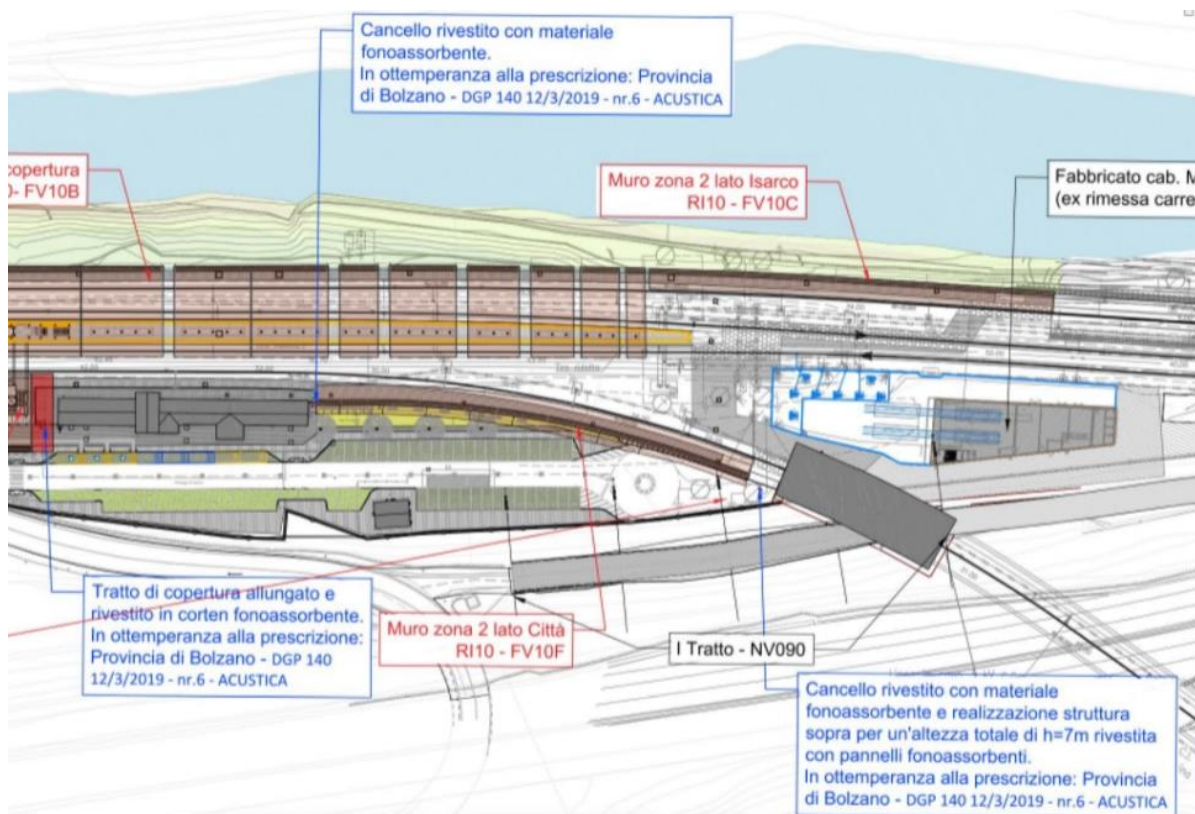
Ridefinizione degli interventi di mitigazione acustica nell'ambito di stazione di Ponte Gardena nel PE
